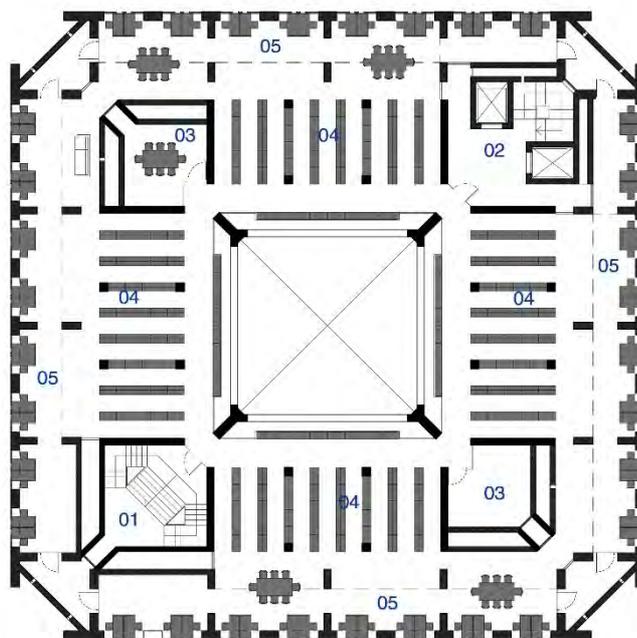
| Planta do quarto pavimento [redesenho do autor]
